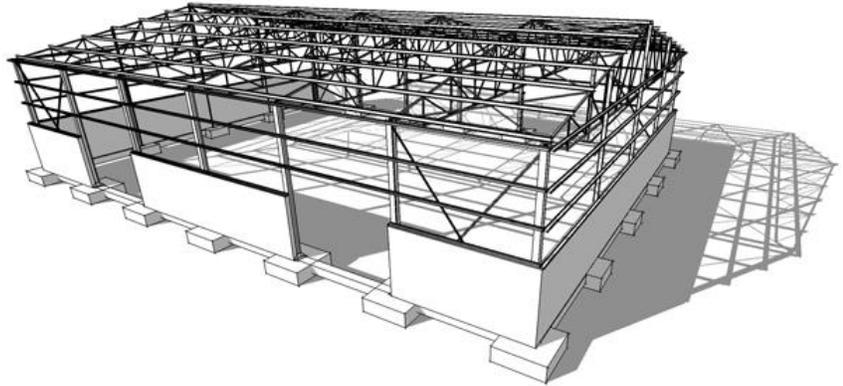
Modelo 3D de la estructura de la cubierta de un edificio.
